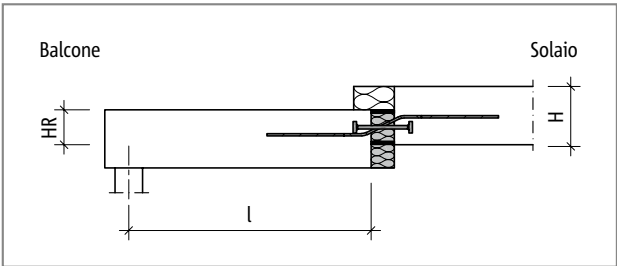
Schöck Isokorb® tipo QL-UD: schema statico
